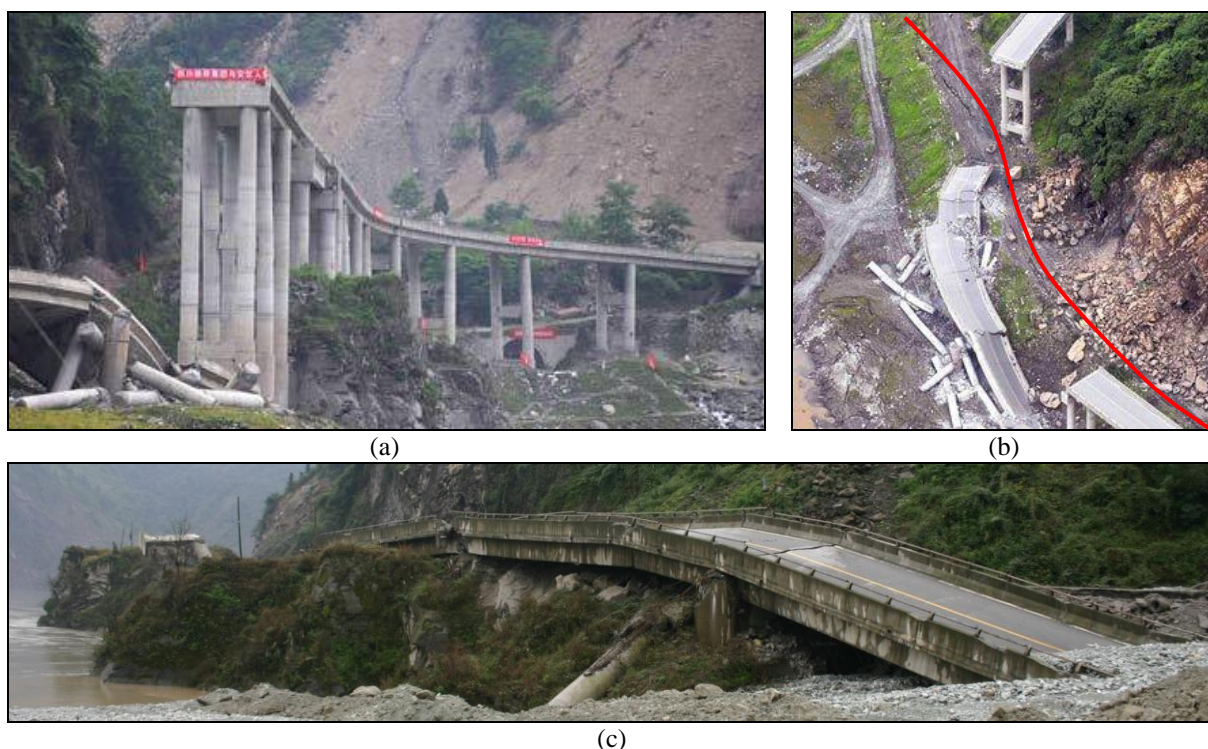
Ponte Baihua: a) após o sismo; b) pormenor da zona de colapso com marcação da falha; c) após demolição
